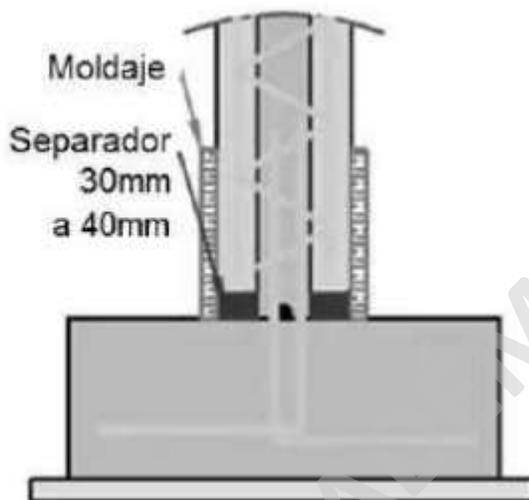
Separación de muro y cimientos, fuente Sirve (2018).
